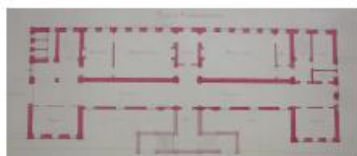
Plan du rez-de-chaussée, extrait du Projet de construction de l'établissement thermal du Bouridé, 1874.
